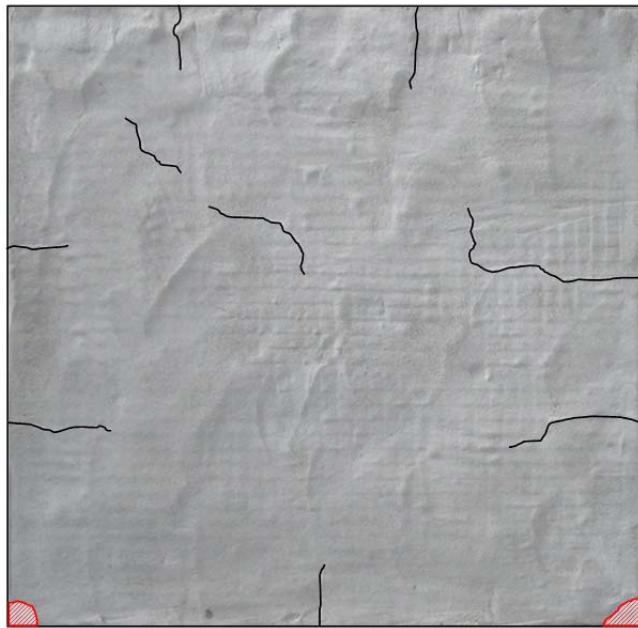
No. 2 浮き・ひび割れ発生状況[P4]
